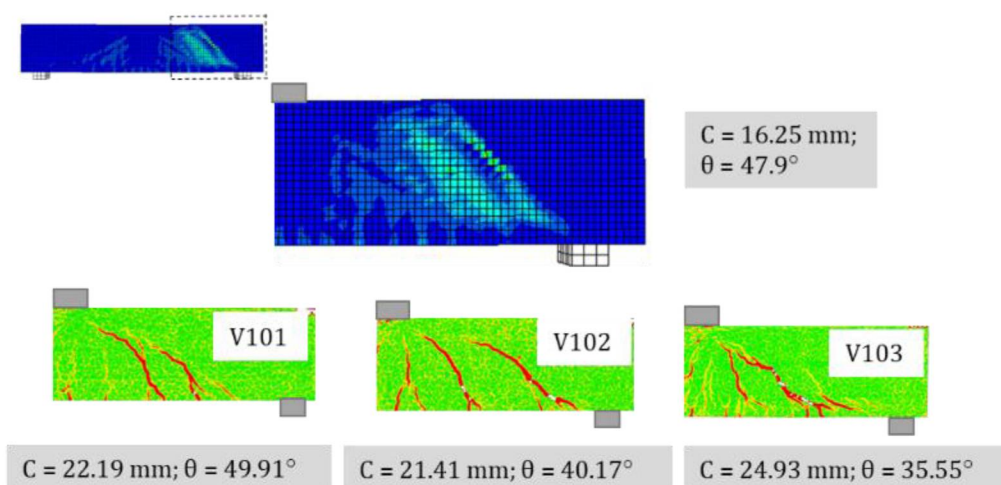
Padrão de fissuração, altura da zona comprimida não fissurada (C) e ângulo médio ( $\theta$ ) da fissura diagonal crítica para o concreto C1.0
